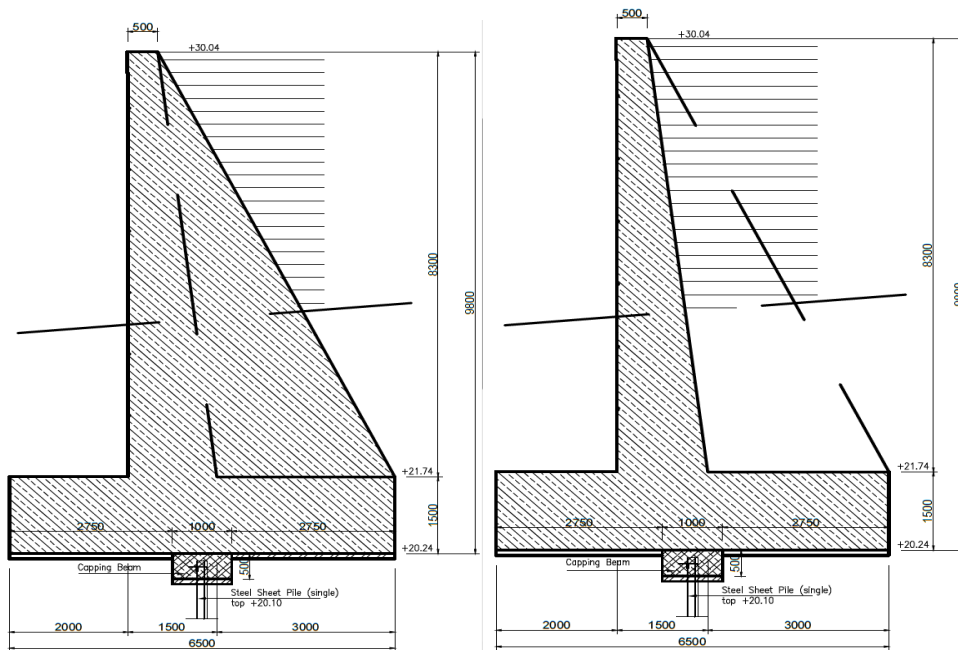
Detail konstruksi dinding penahan tanah tipe A
